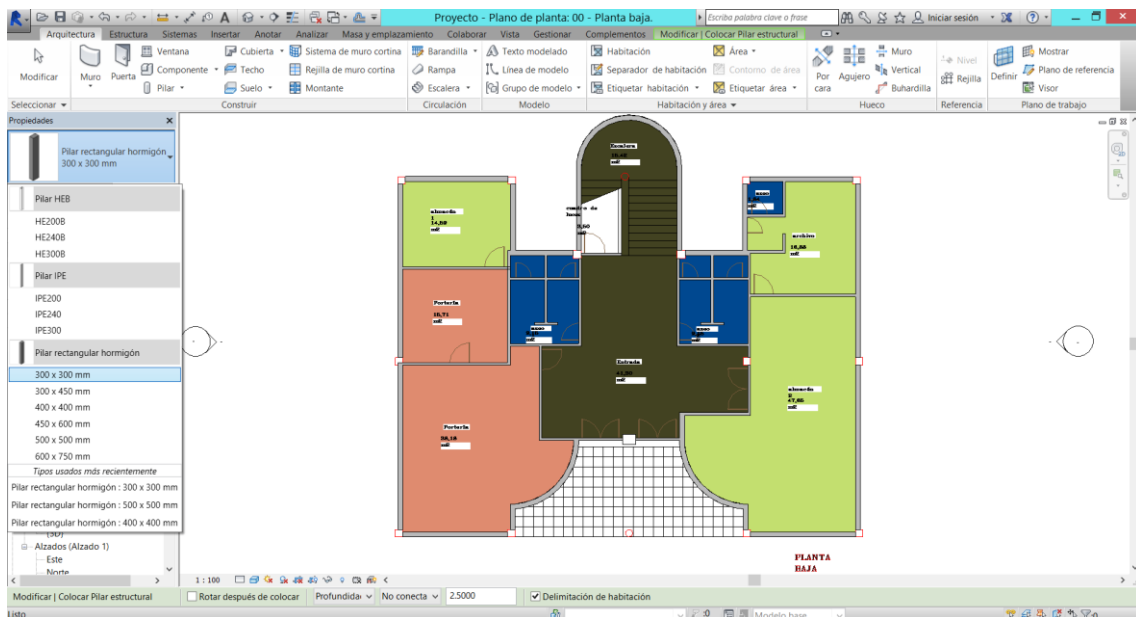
Selección del tipo de pilar estructural. Fuente: Elaboración propia.
